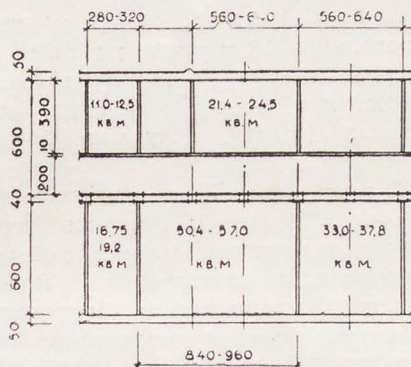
Схема плана здания с двумя пролетами по 6 м
